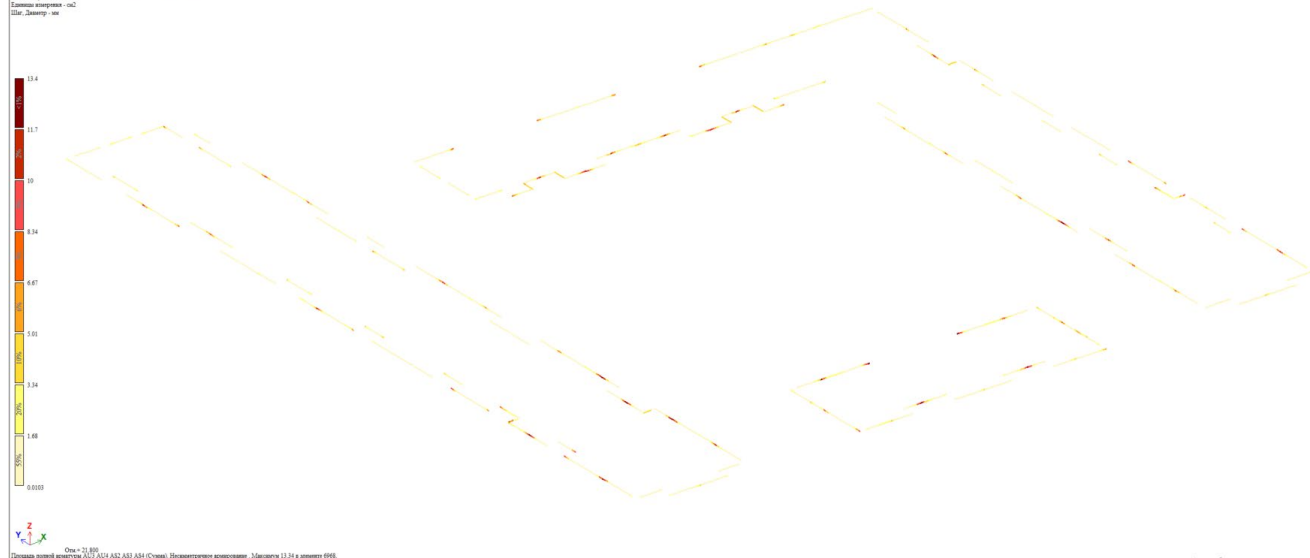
Площадь верхнего армирования балок плиты перекрытия типового этажа
